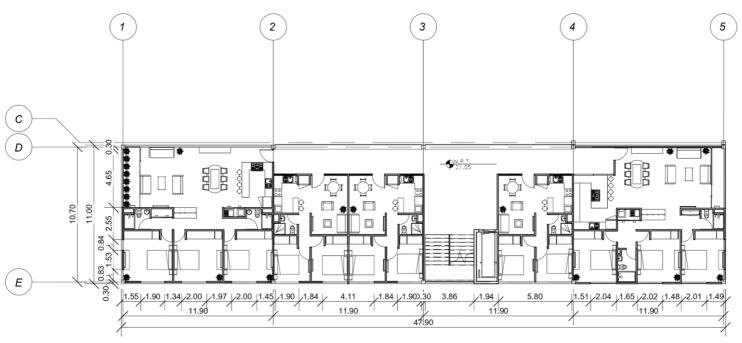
Propuesta final. Planta nivel siete. Elaboración propia. 2022
